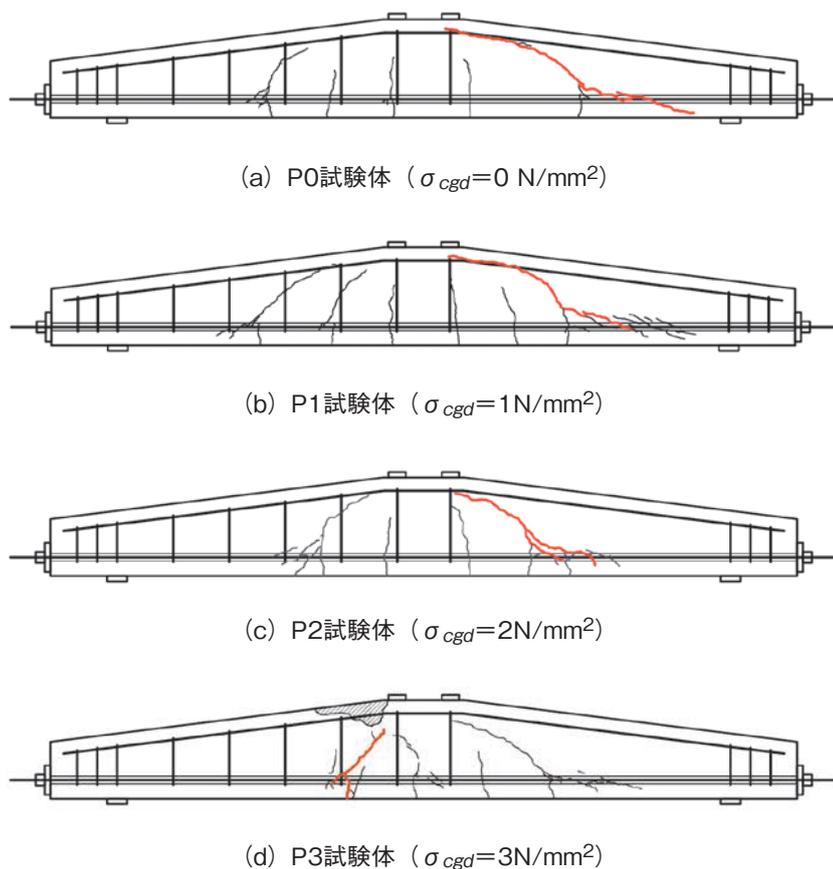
Pシリーズの最大荷重直前のひび割れ性状
